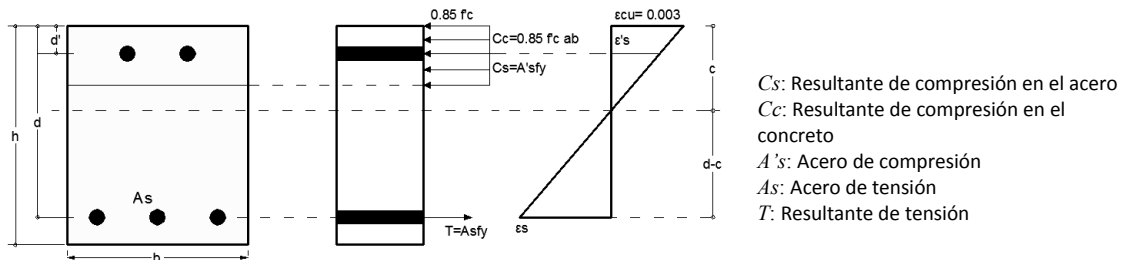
Sección transversal refuerzo en dos lechos (esfuerzo a tensión y compresión)¹⁷.
